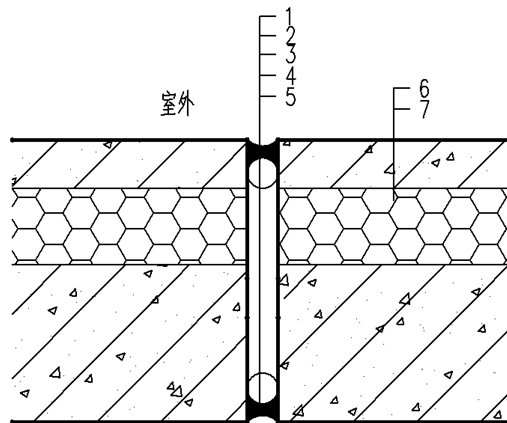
预制混凝夹心保温外挂墙板竖向接缝密封防水构造
